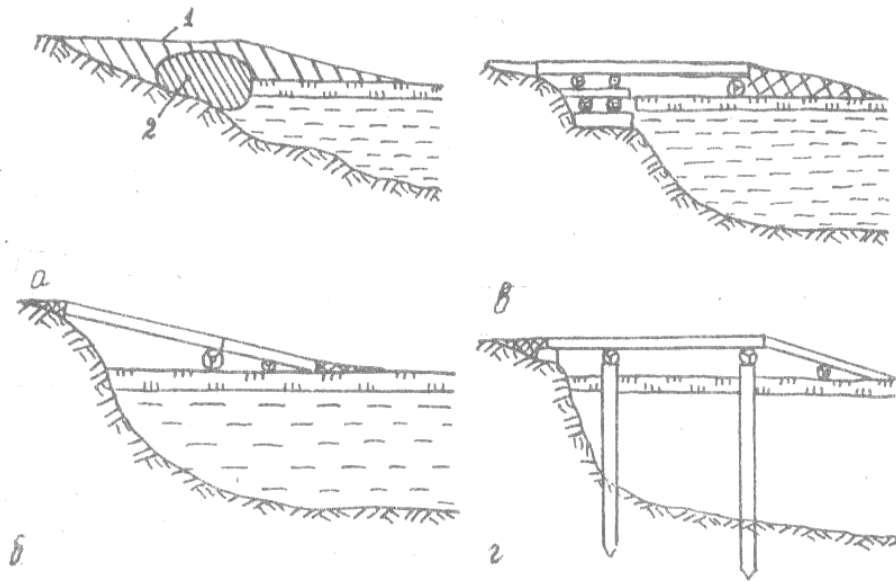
Конструкції з'їздів на льоду: а – сніжно-хмизний; б – з лежнем на льоду; в – з кліткою на березі і лежнем на льоду; г – з естакадою (1 – шар ущільненого снігу; 2 – хмизові фашини)
